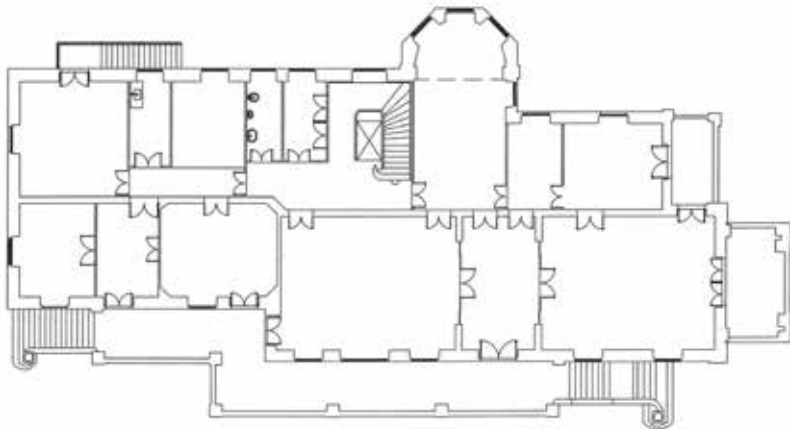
Levantamento cadastral da Villa Catharino. Planta Baixa do primeiro pavimento. Fonte: JORDAN et alli. 2006, p. 93.
